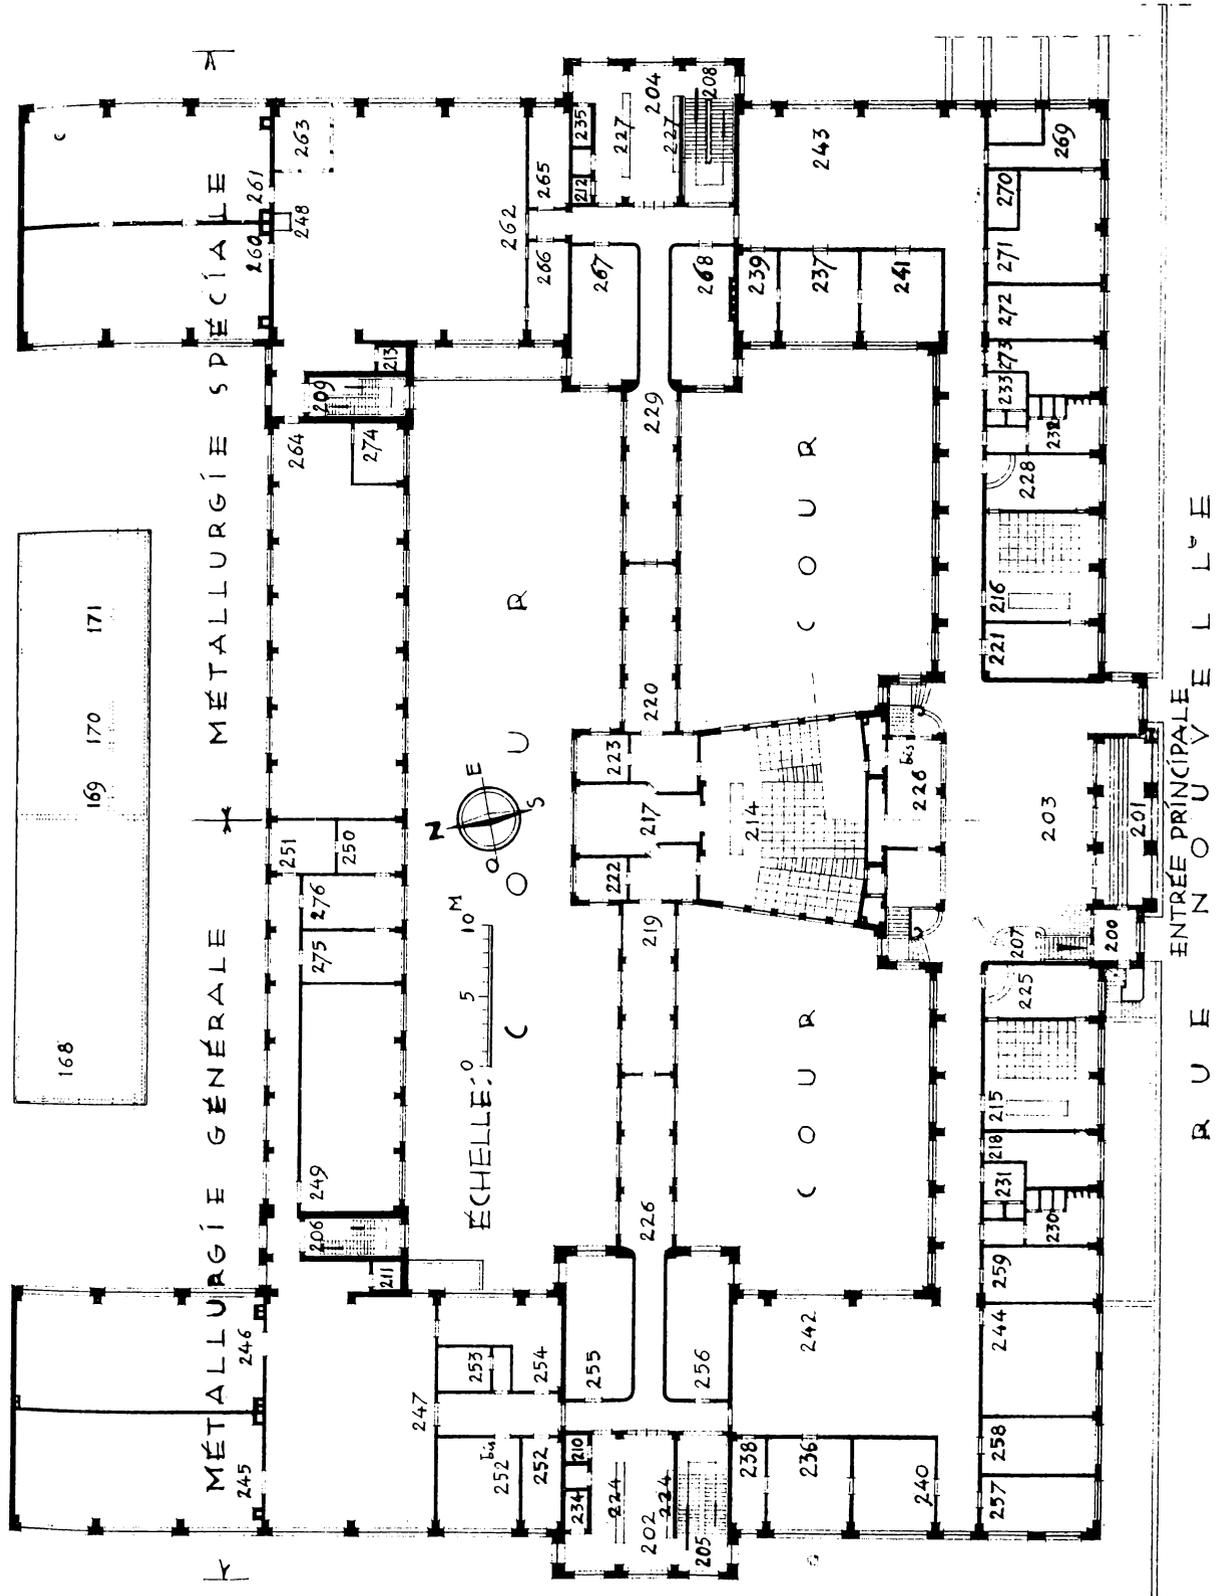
Université de Liège. Institut de Chimie et de Métallurgie. Plan du rez-de-chaussée.
